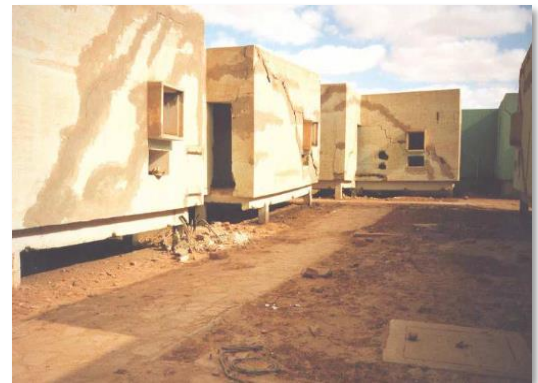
Fissures diagonales (Derriche Z et al.)
